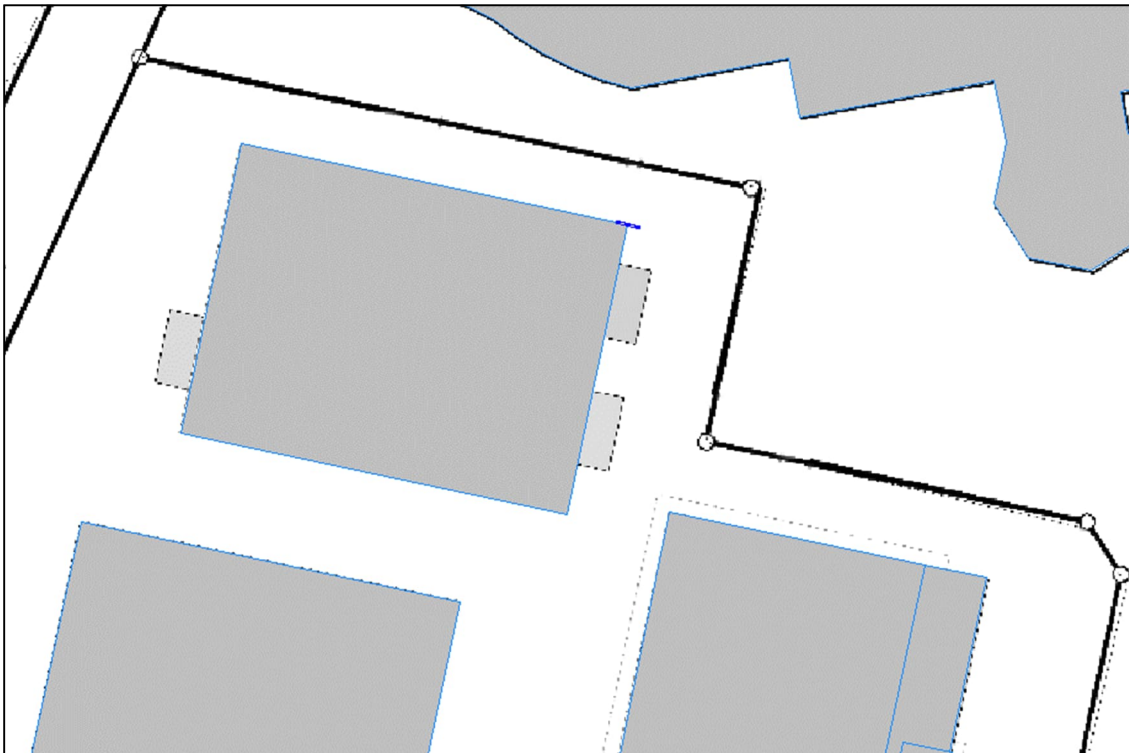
Lageplan mit Darstellung der benötigten Wandverlängerung
